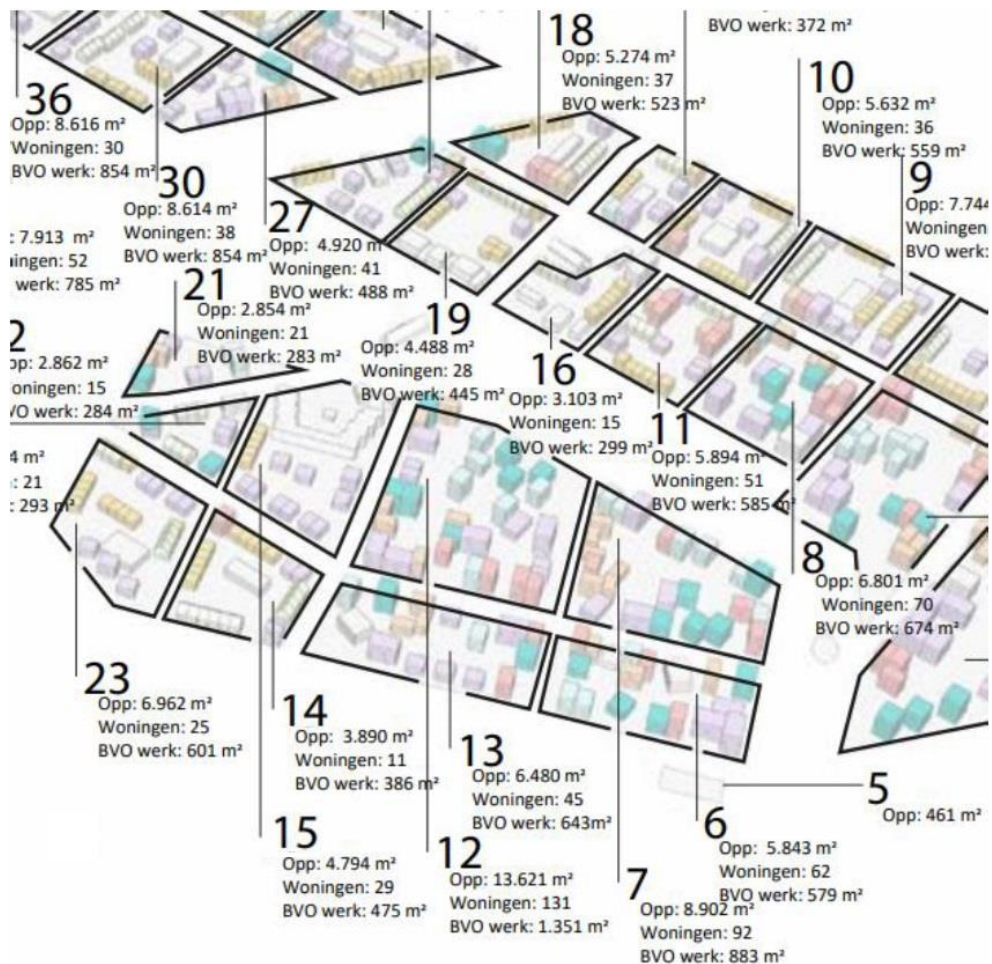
Uitsnede Stedenbouwkundig Masterplan, met globale aanduiding van het besluitgebied
